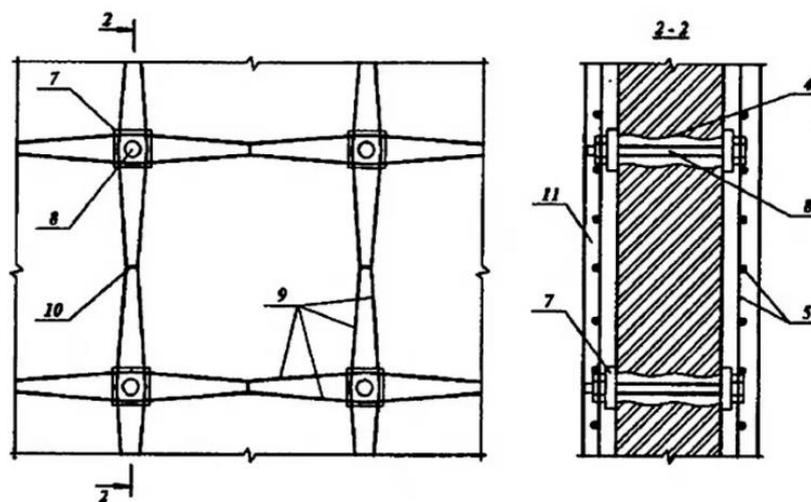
Усиление стен штукатурной предварительно-напряженной обоймой [1], где 1 – усиливаемая стена; 2 – арматурные стержни; 3 – хомуты-связи; 4 – отверстия в стене; 5 – арматурные сетки; 6 – бетон обоймы; 7 – стальные пластины с отверстиями для тяжей; 8 – тяжи-связи; 9 – арматурные стержни; 10 – сжимы; 11 – штукатурка из ц/п раствора
